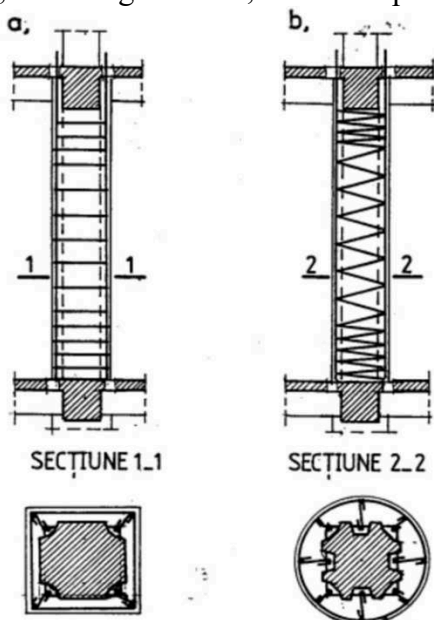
Cămășuială de beton cu armături suplimentare [2], [3]
